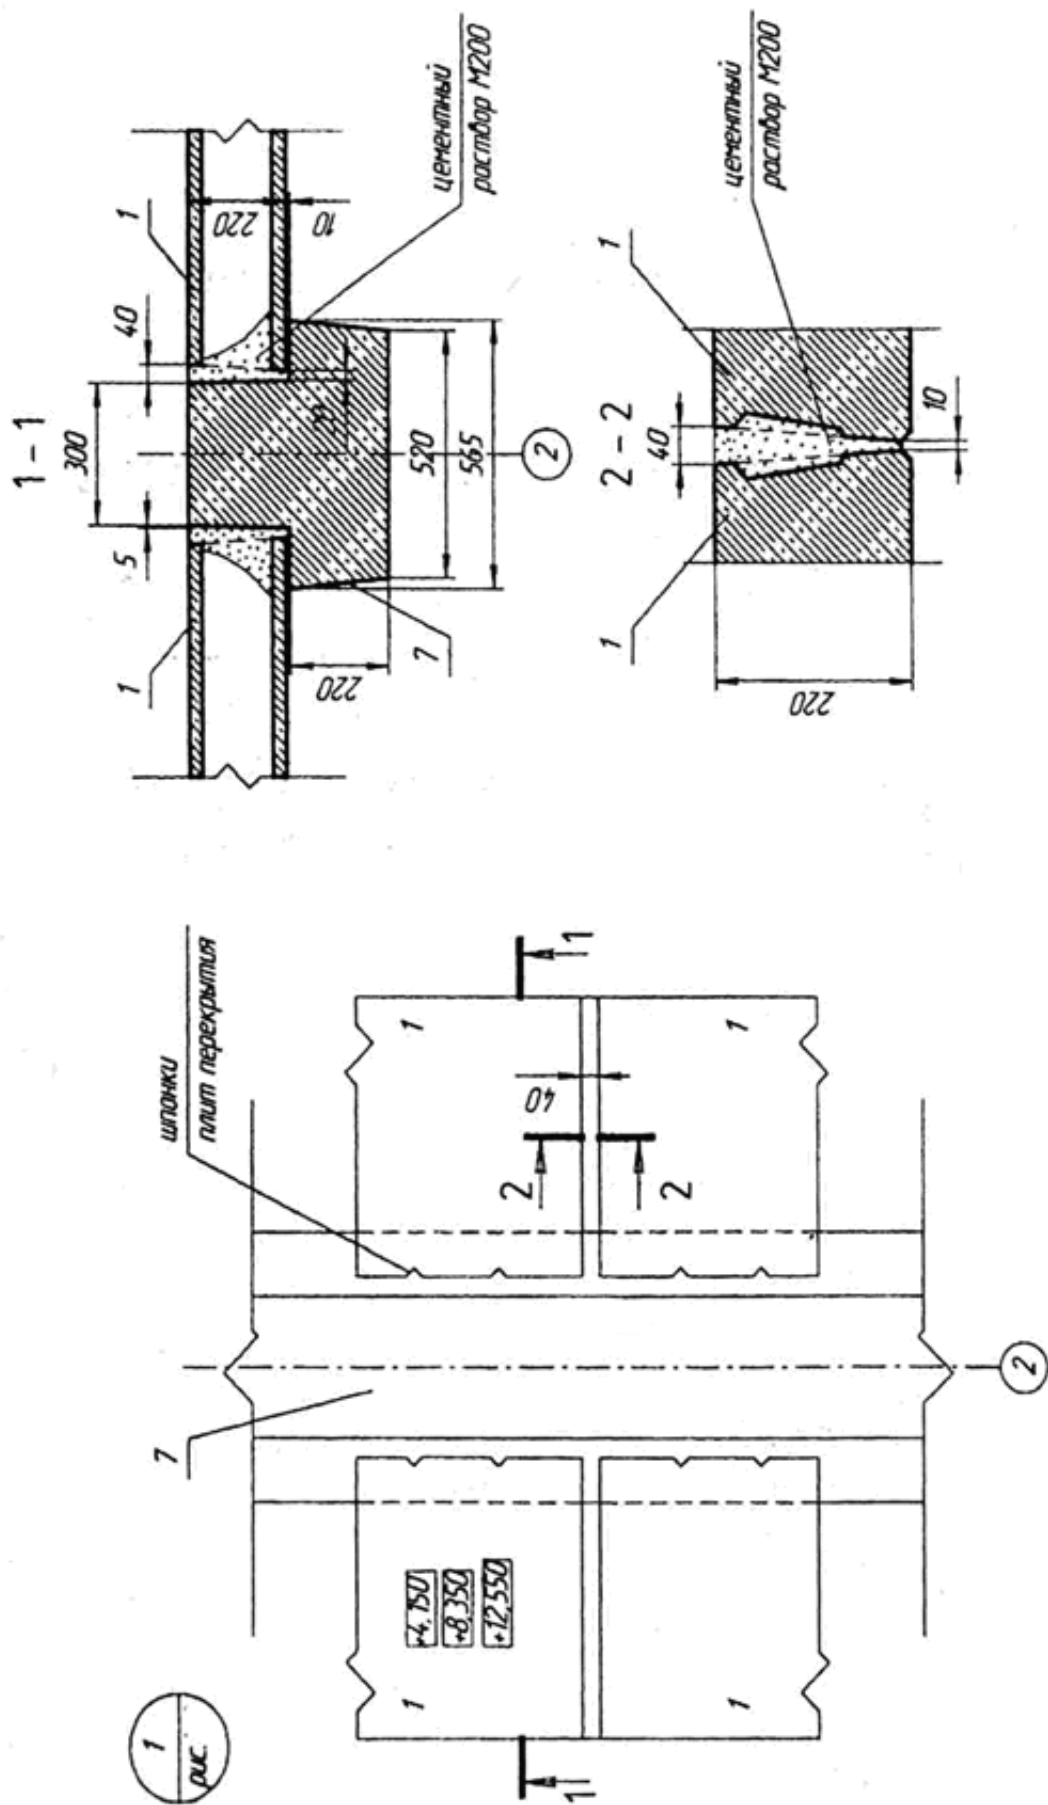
Узел сопряжения ригеля и плит перекрытия
